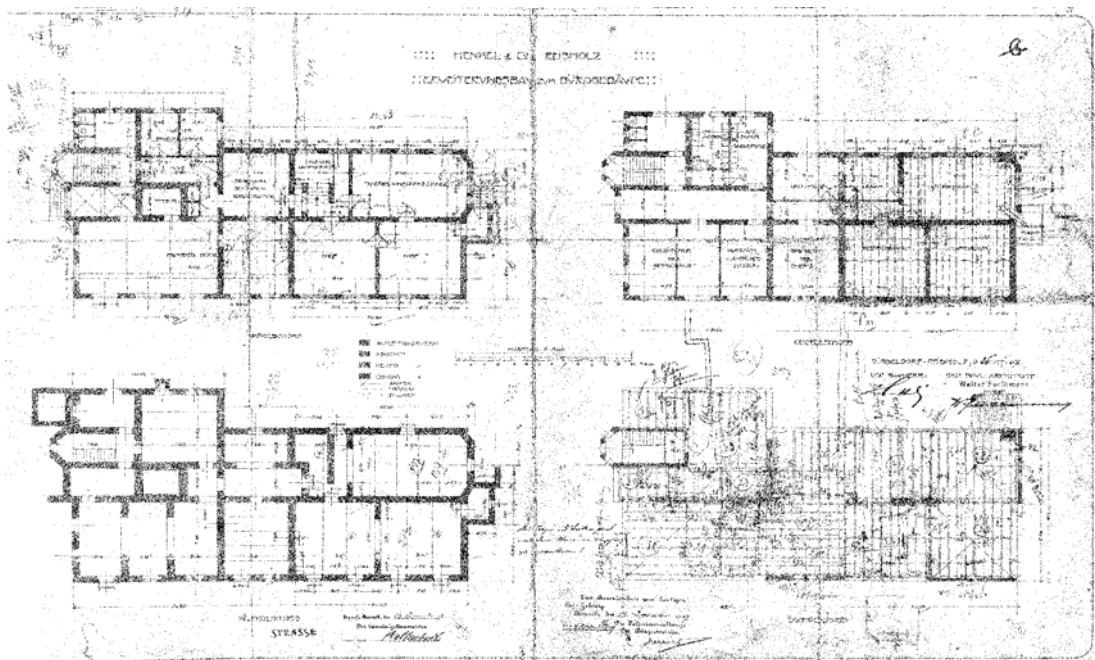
Verwaltungsbau – Grundrisse, bauliche Erweiterung 1907 – Architekt: Walter Furthmann
